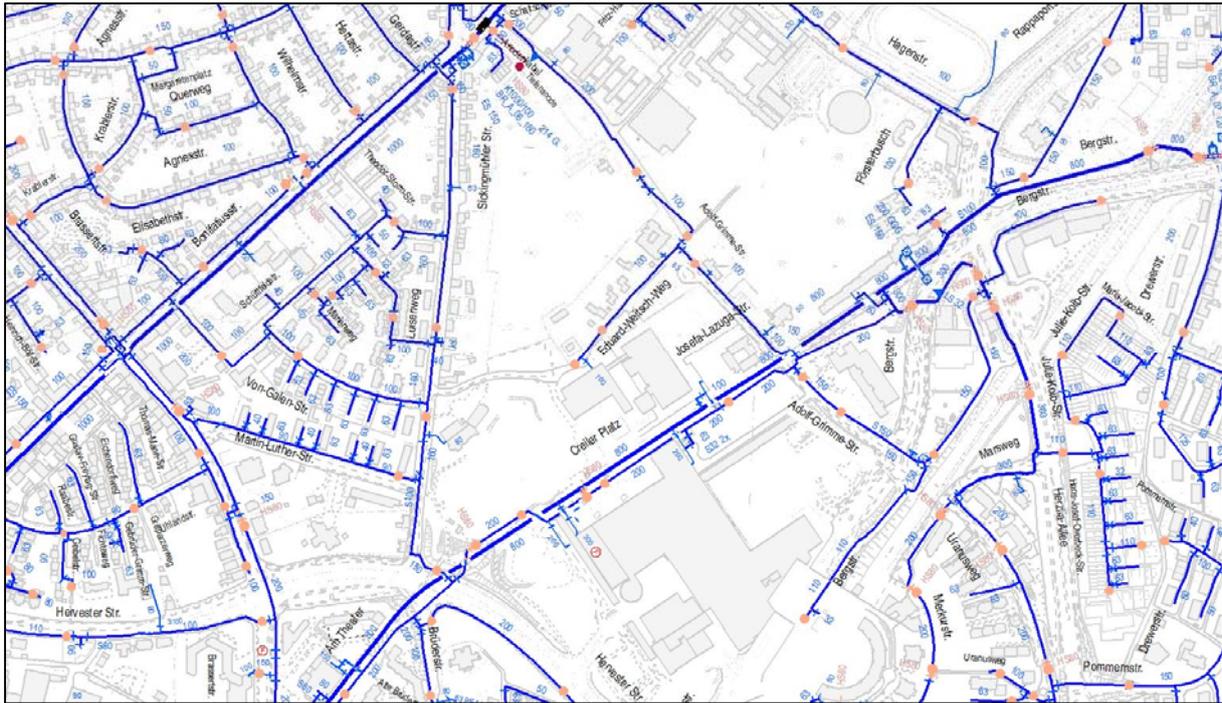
Ausschnitt Hydranten-Plan in Marl (rosa Punkte: Hydranten)
